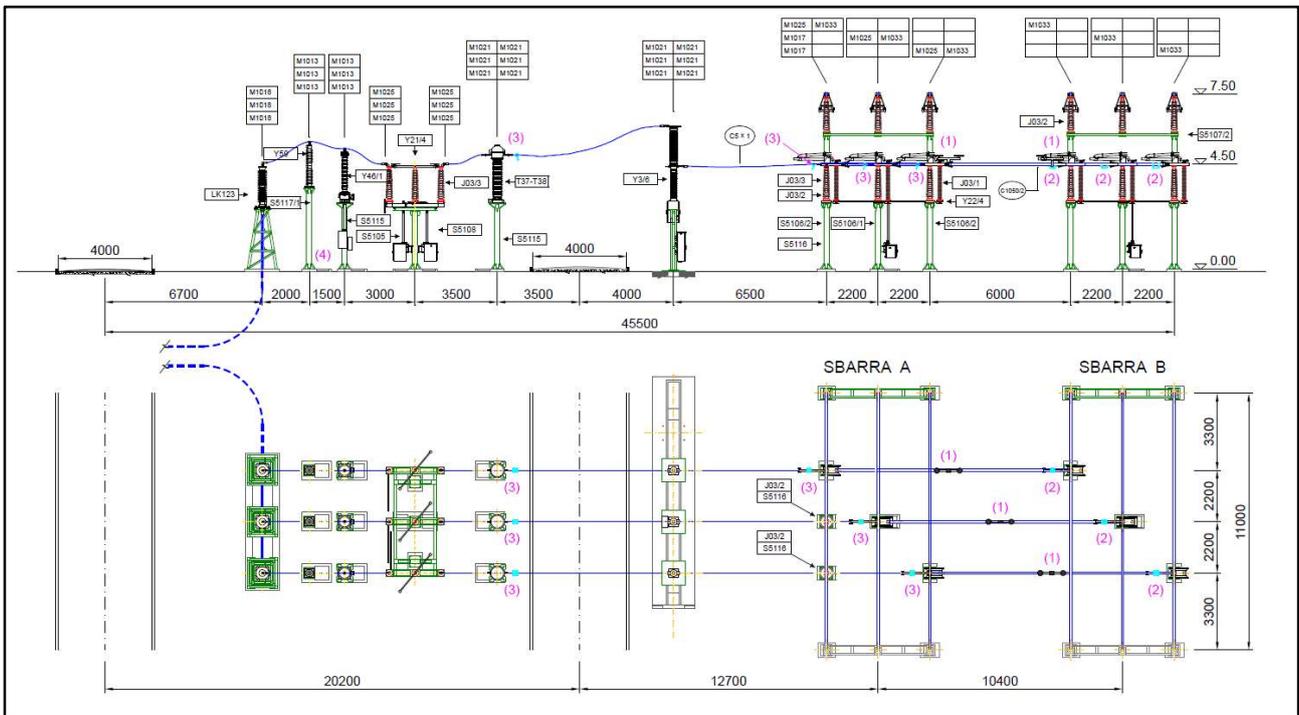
Planimetria e sezione elettromeccanica relativa alle apparecchiature dello stallo 150 kV nella stazione Terna
